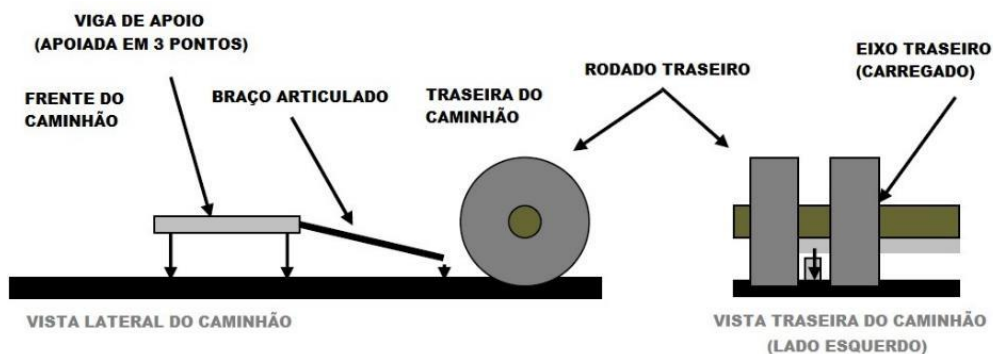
LOCALIZAÇÃO DA VIGA
